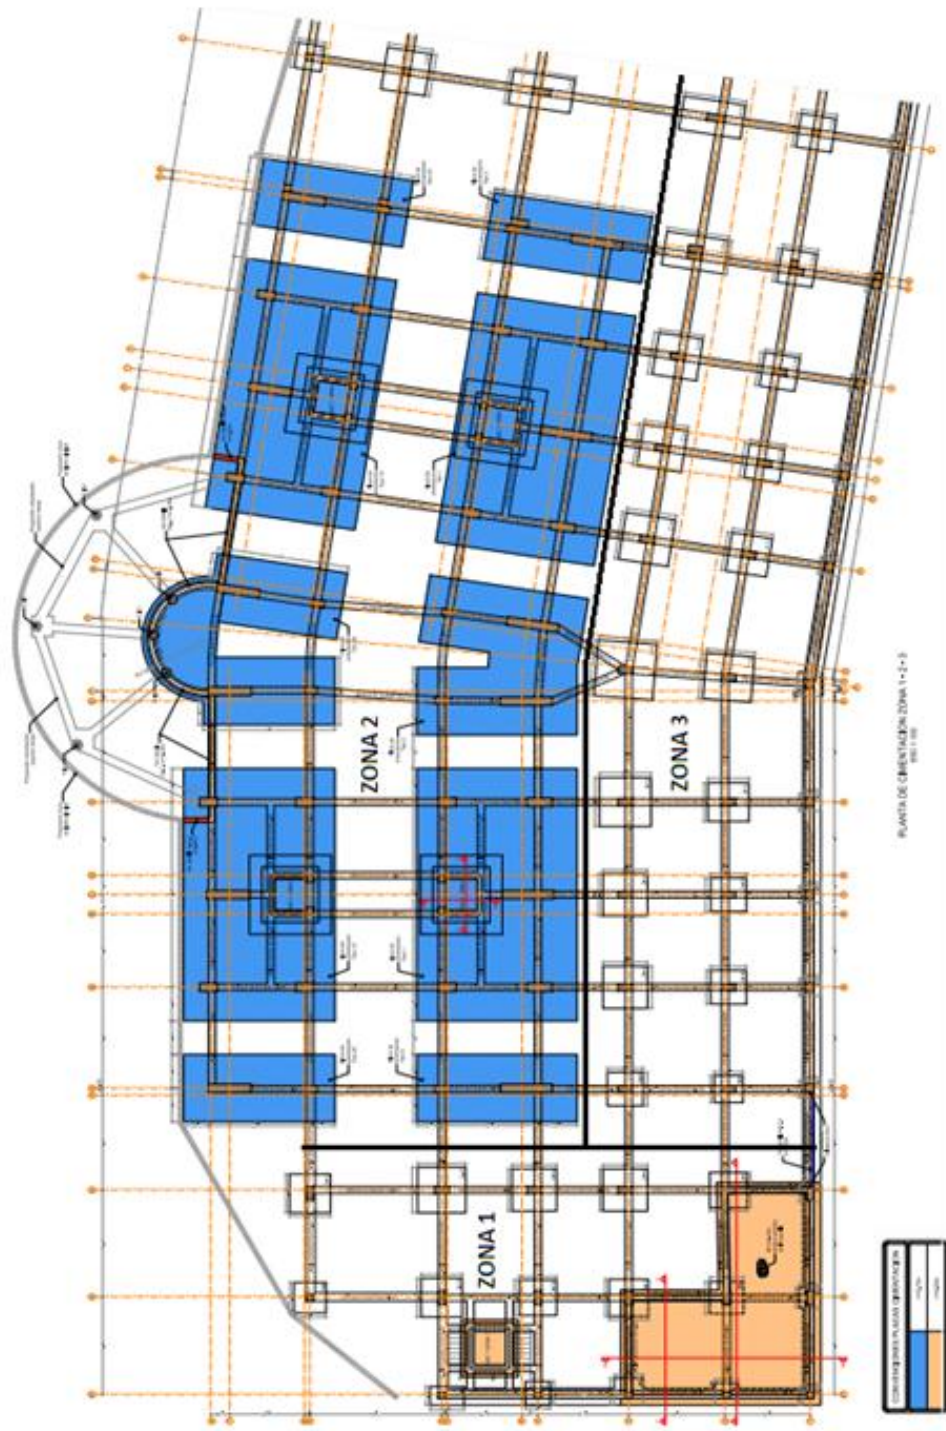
Plano 3ES-101 zona 1,2 y 3 planta de cimientos
